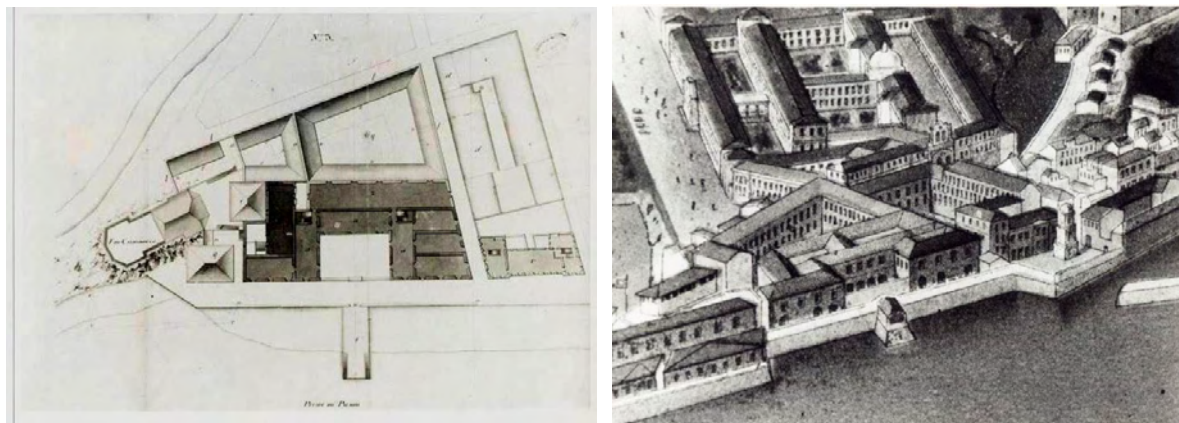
e 70 - Planta baixa e gravura do século 18. Bateria de São Tiago, Arsenal de Guerra, Beco da Batalha e Casa do Trem.
